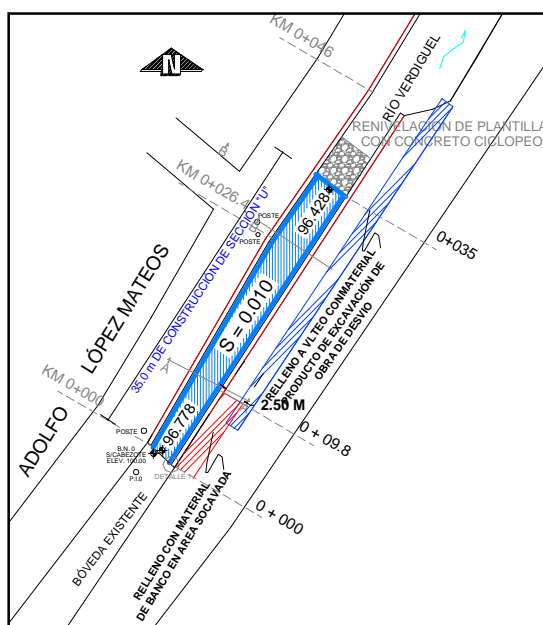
PLANTA DE BÓVEDA CASO II
